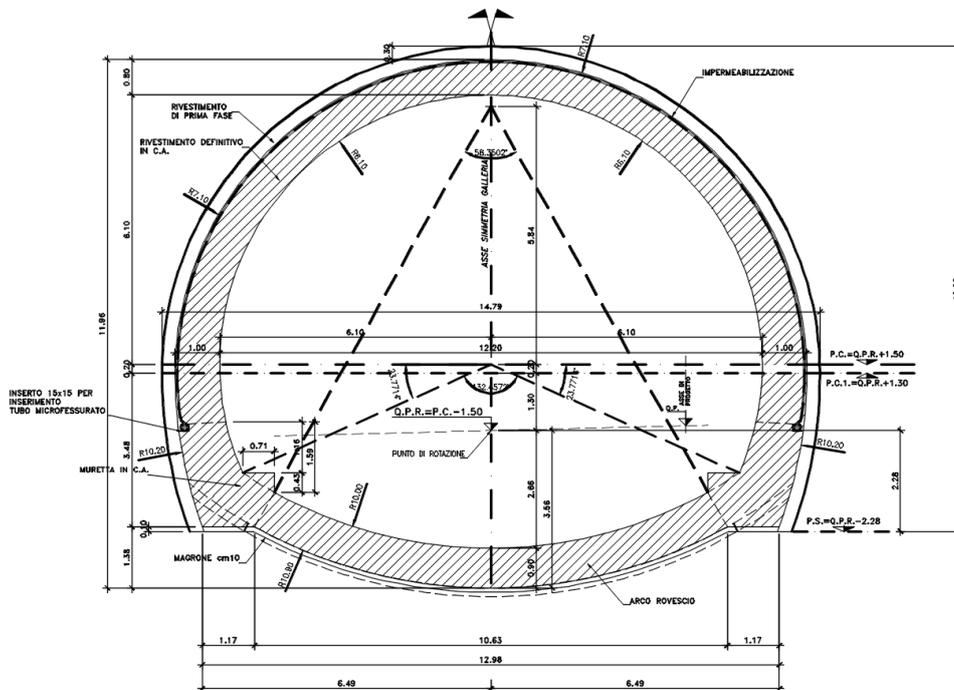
Sezione trasversale tipologica galleria naturale GN02
